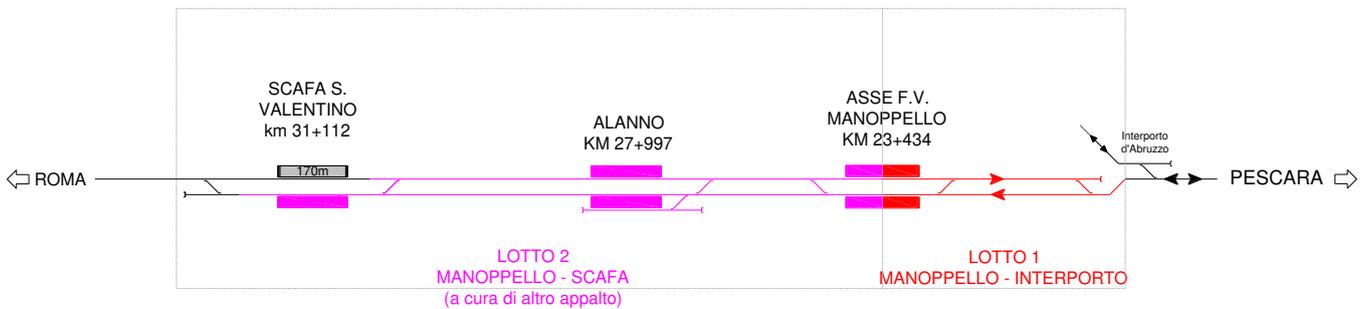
Layout di progetto raddoppio completo Lotto 1 e Lotto 2 (a cura di altro appalto)
